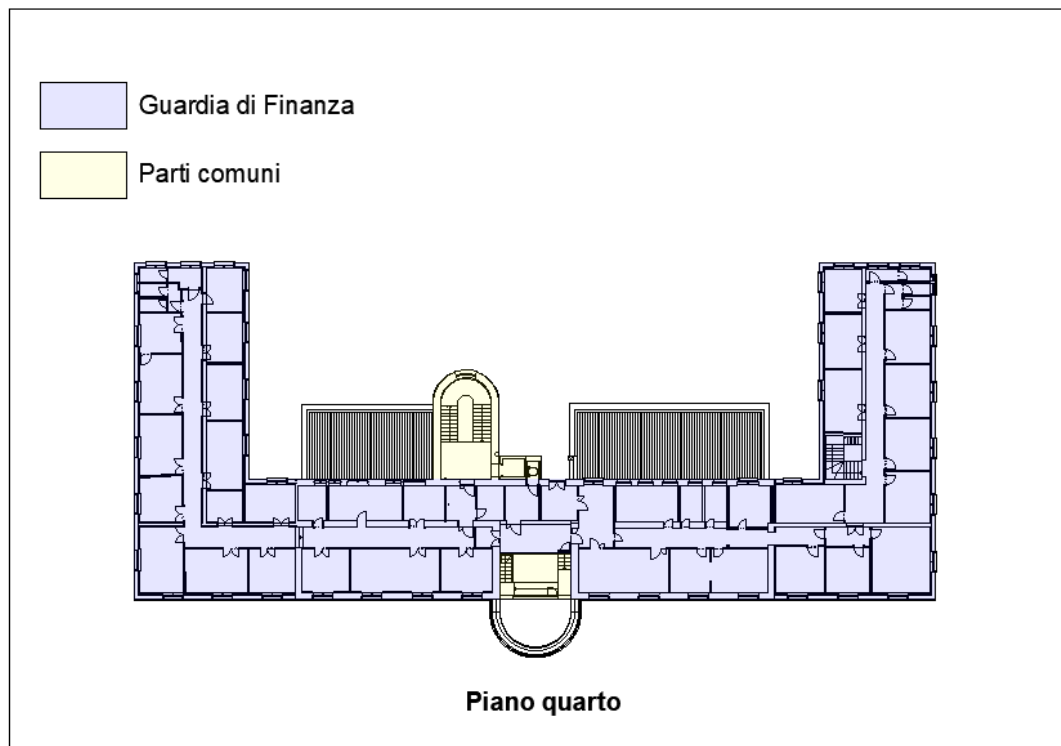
Pianta piano quarto: piano di razionalizzazione e future Amministrazioni utilizzatrici
